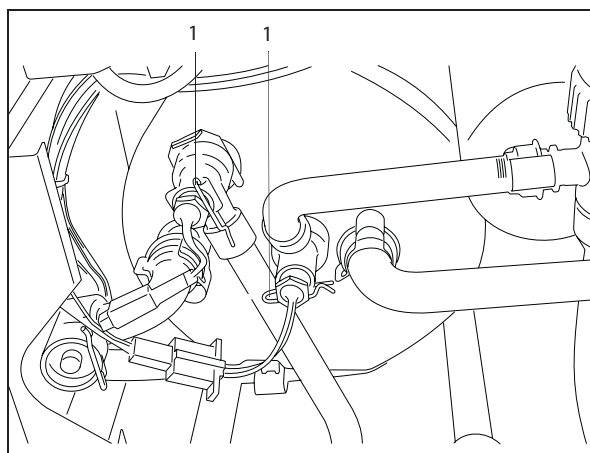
Smontaggio dei sensori di Standby e dell'acqua calda
